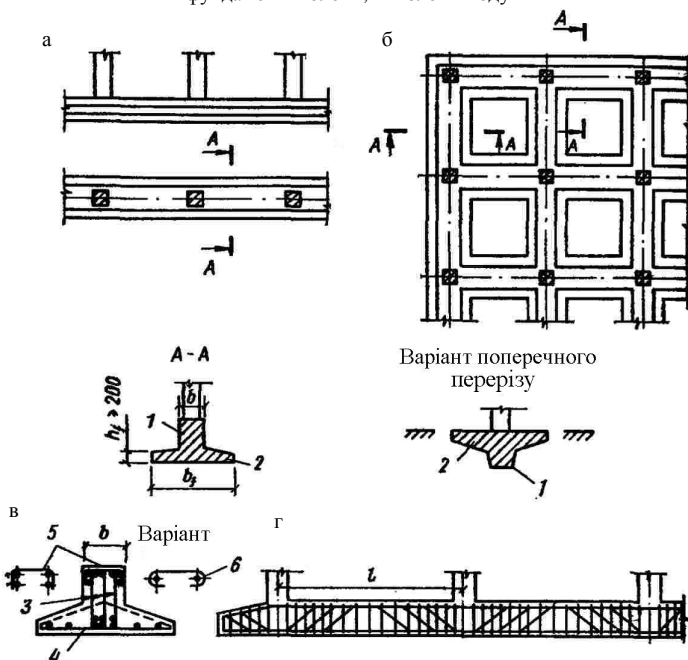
Стрічкові монолітні фундаменти під колонни:
